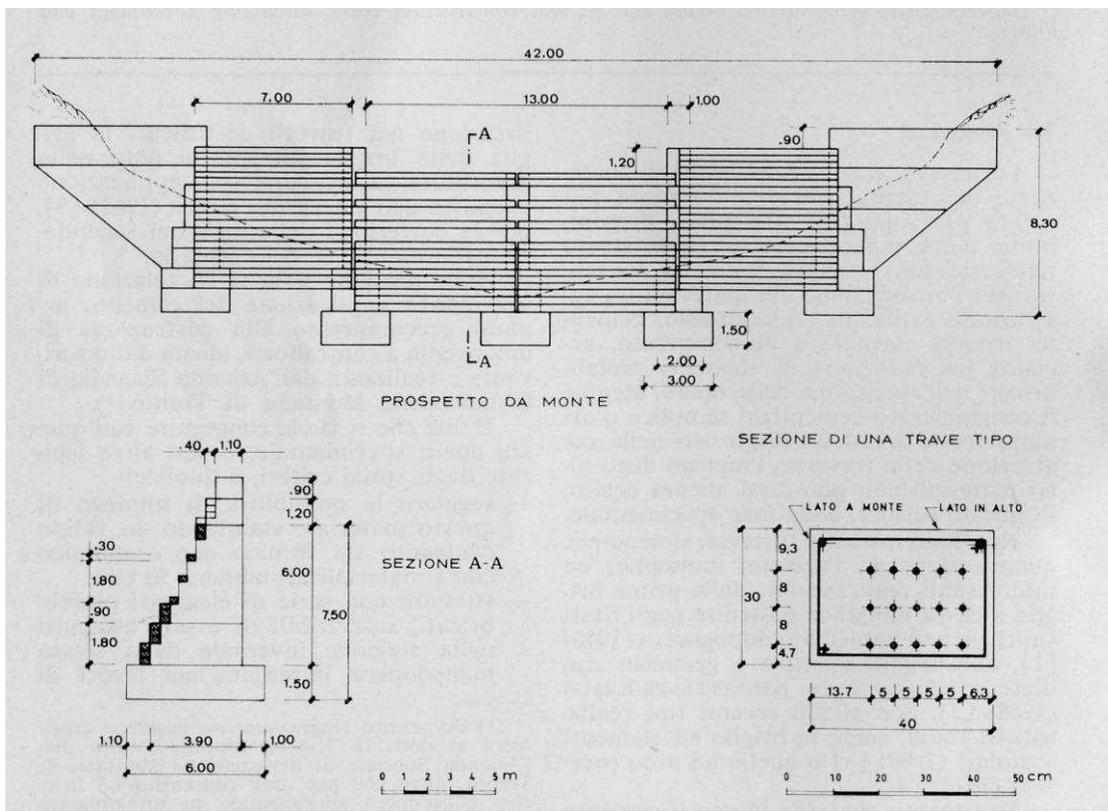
Dique con contrafuertes parcialmente prefabricado con vigas en cemento armado precomprimido, proyectado por Fattorelli (1972).
